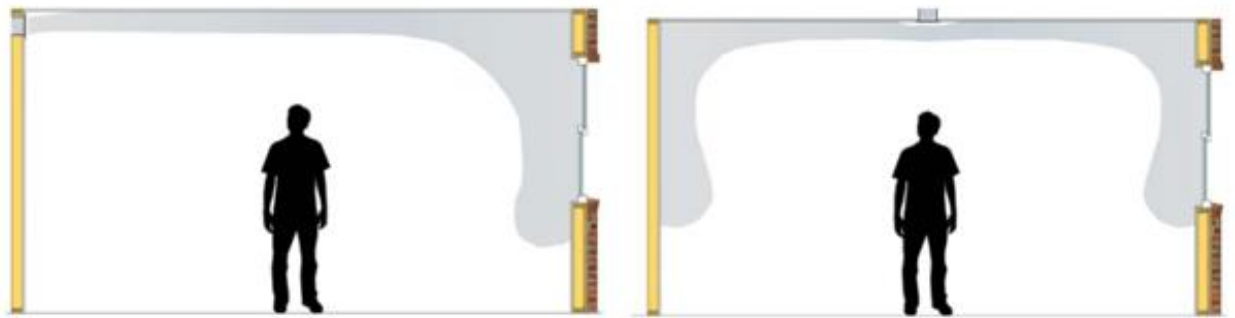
rejillas de suministro (a) en pared, (b) en techo.
